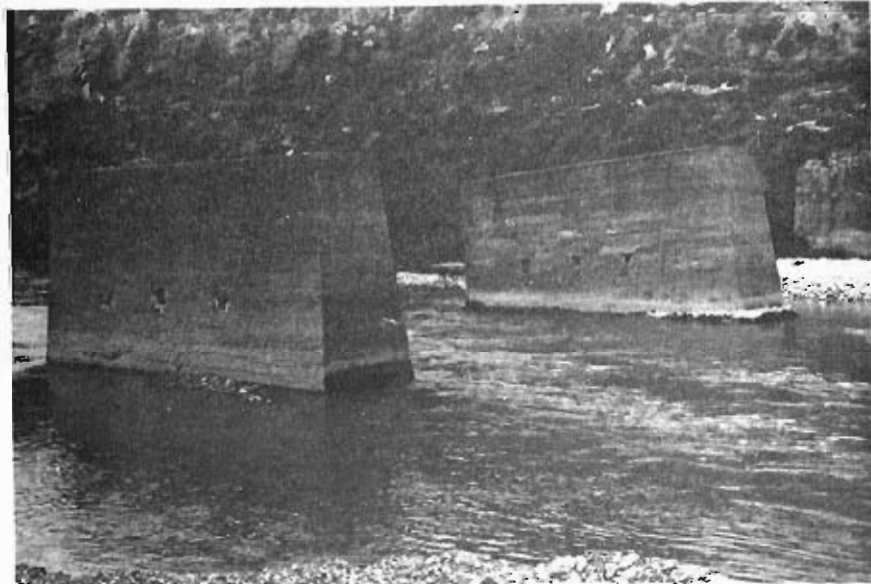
Fenómenos de socavación del río Alcanadre en Pertusa. Se aprecia la inclinación hacia aguas arriba de una pila, que ha provocado la ruina del puente.
